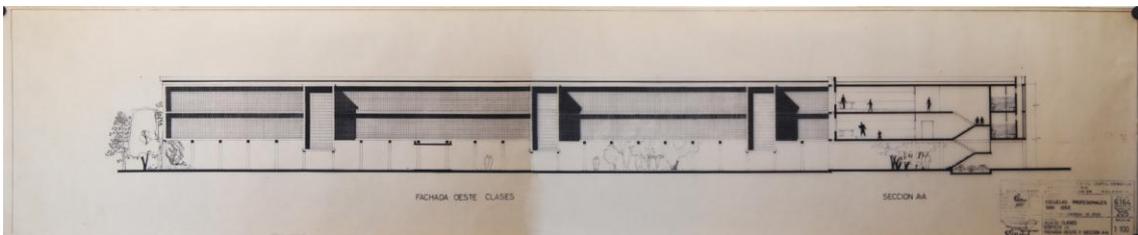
Fachada oeste clases. *Archivo Escuelas San José.
